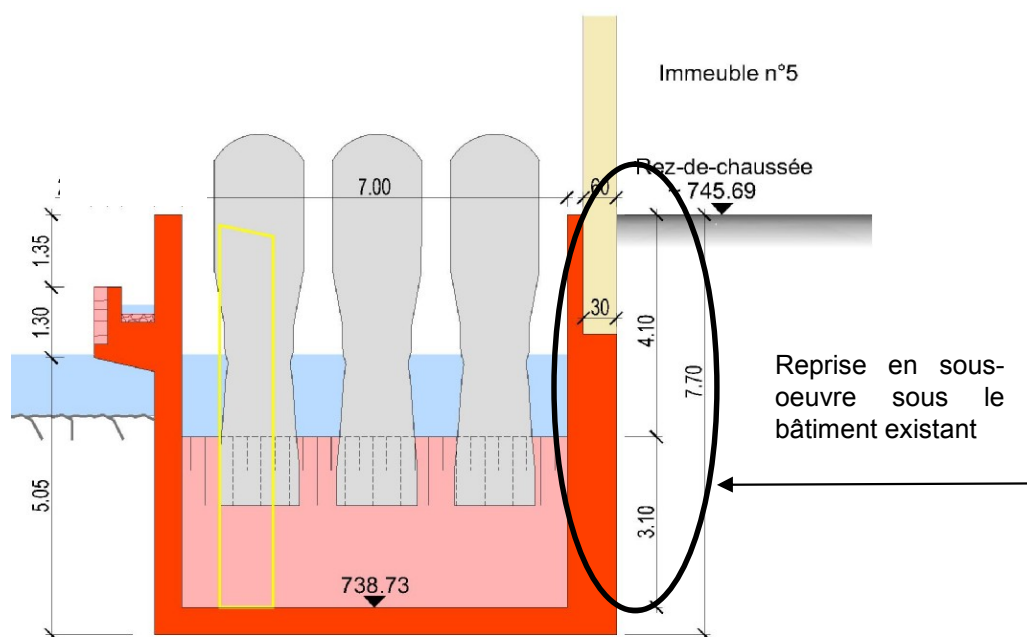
Zone de reprise en sous-œuvre du bâtiment existant
